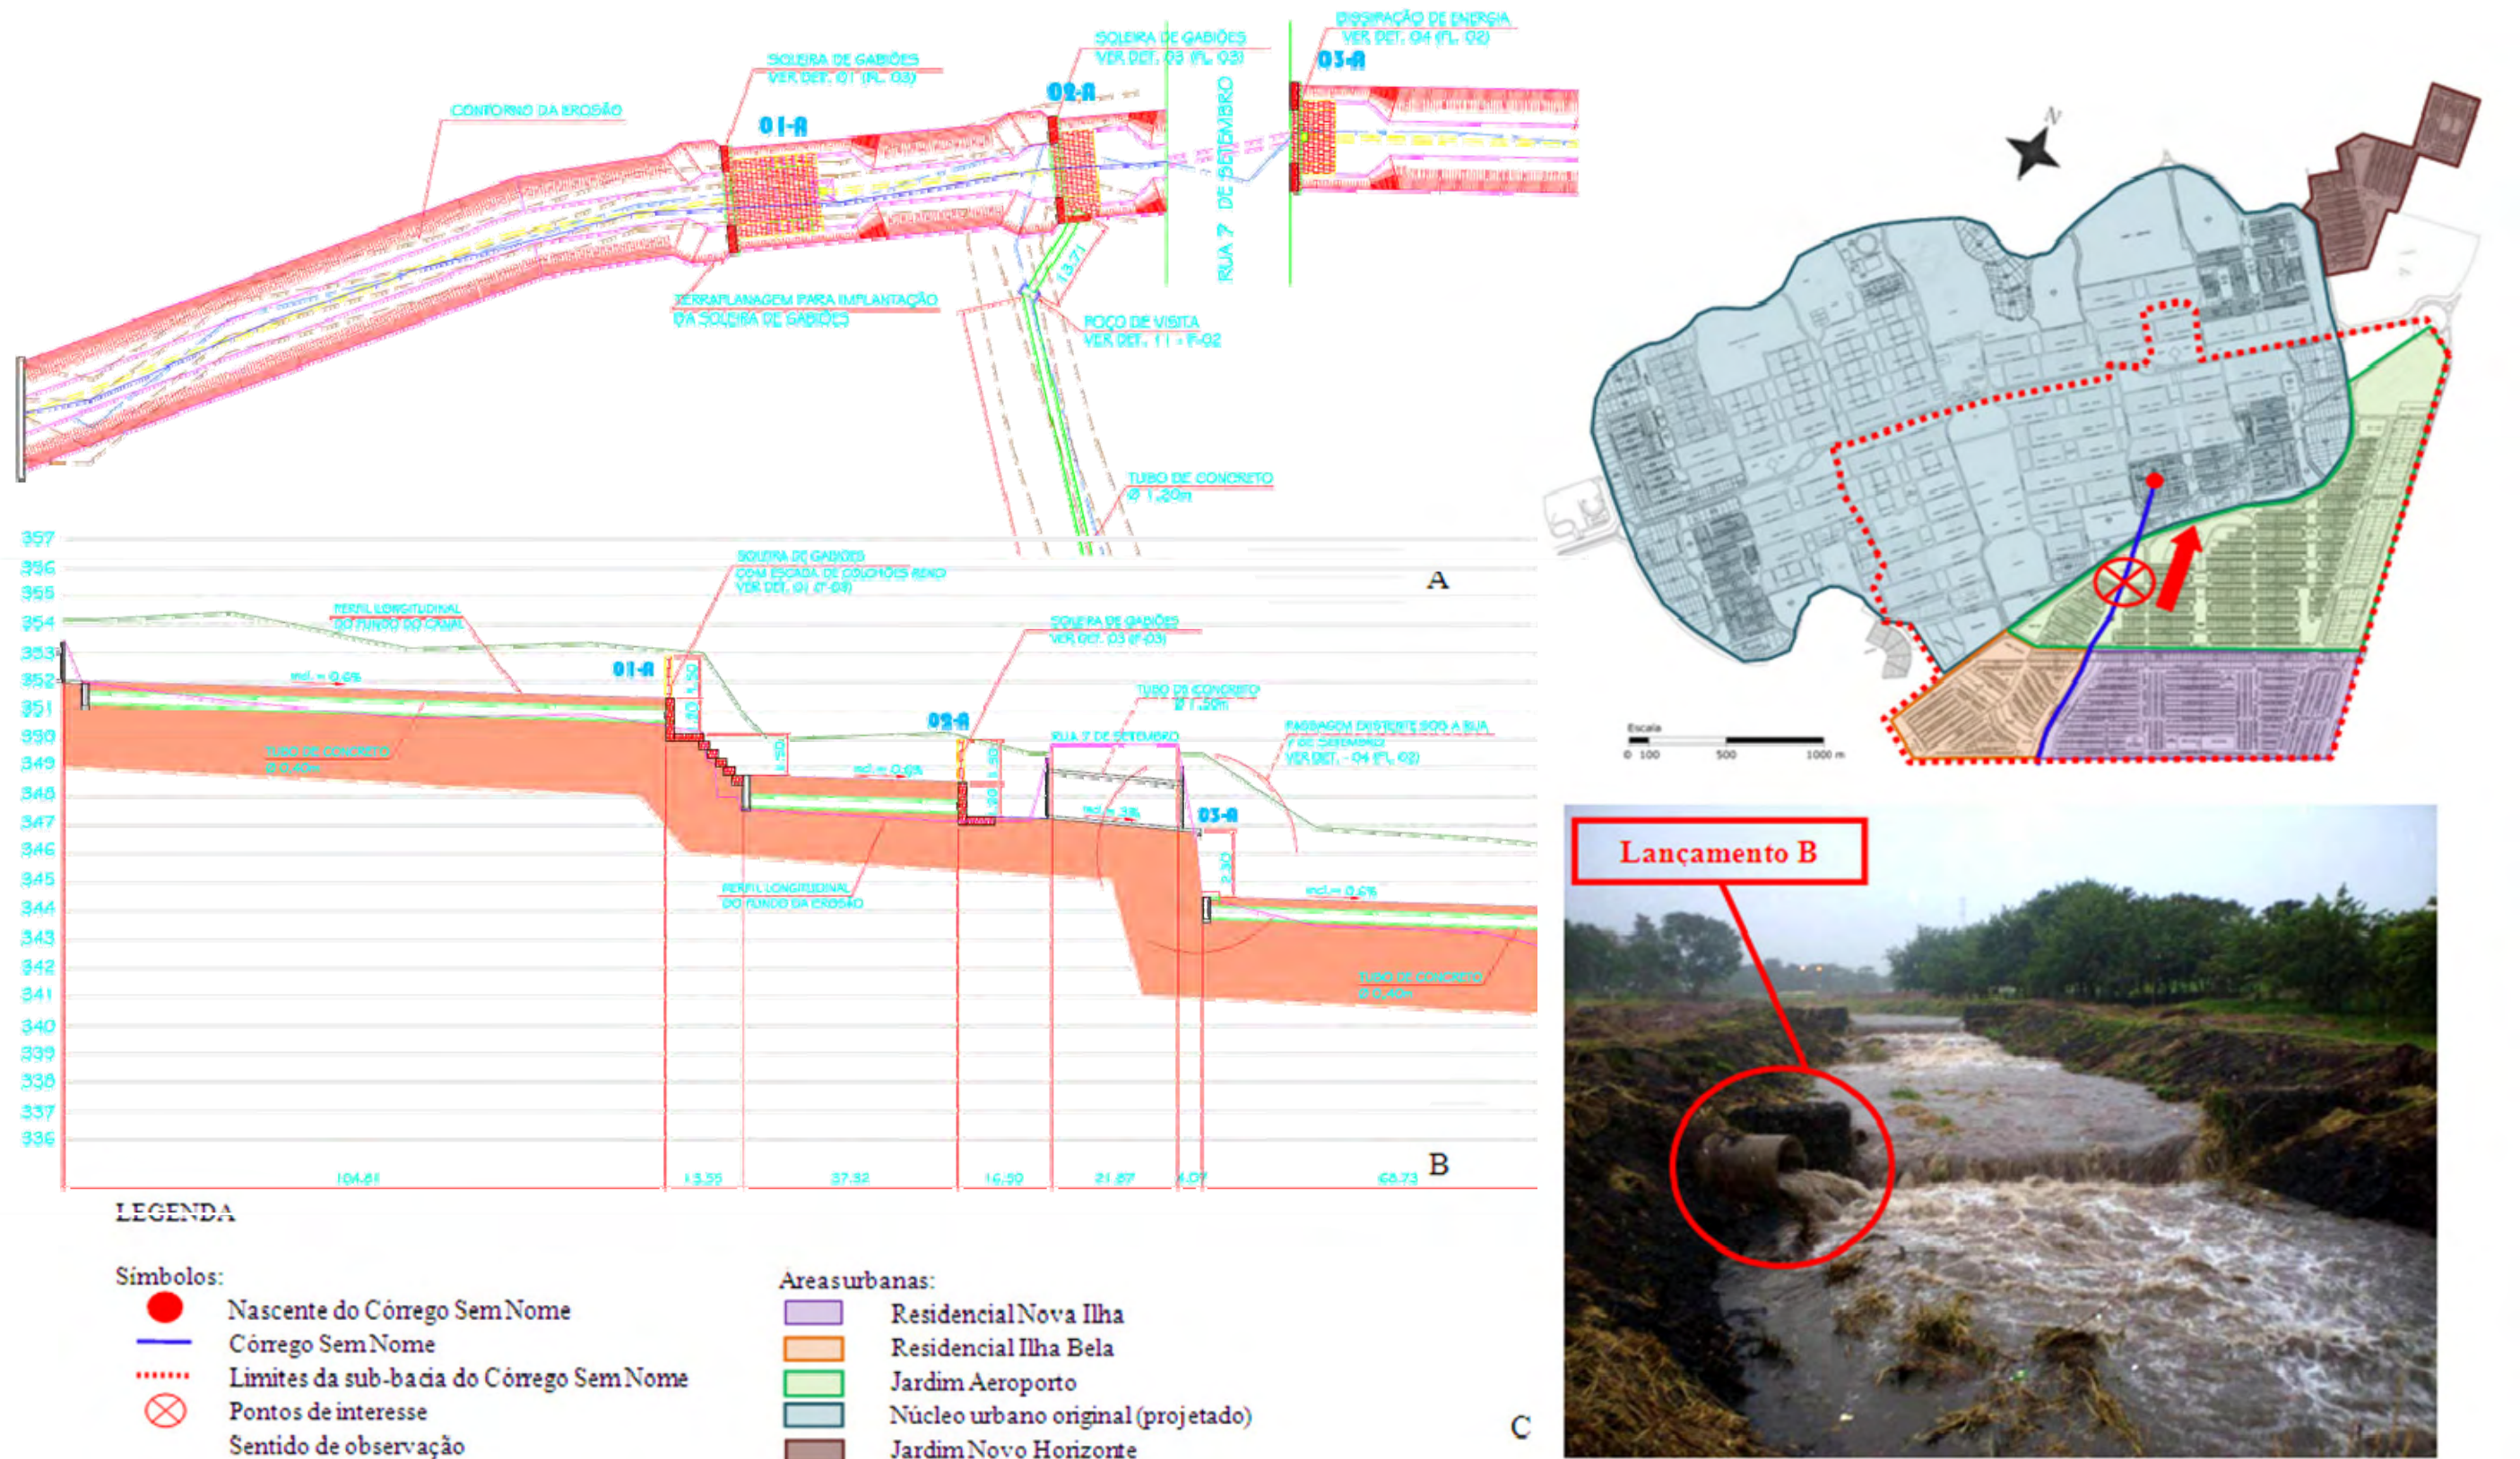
Trecho 2 em planta (A), em perfil (B) e foto (C) (Fonte: (A) e (B) Ilha Solteira (2007) e (C) arquivo pessoal Thiago Santim, 16/05/2008)
